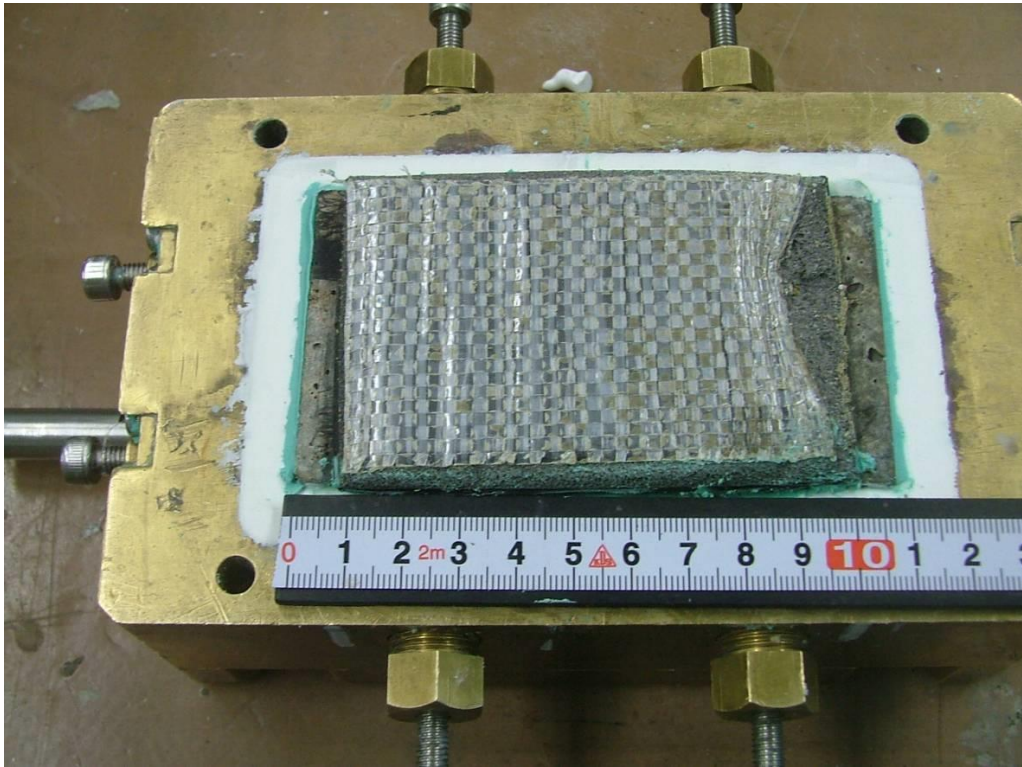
一方向載荷試験 一方向載荷試験後の供試体状況
